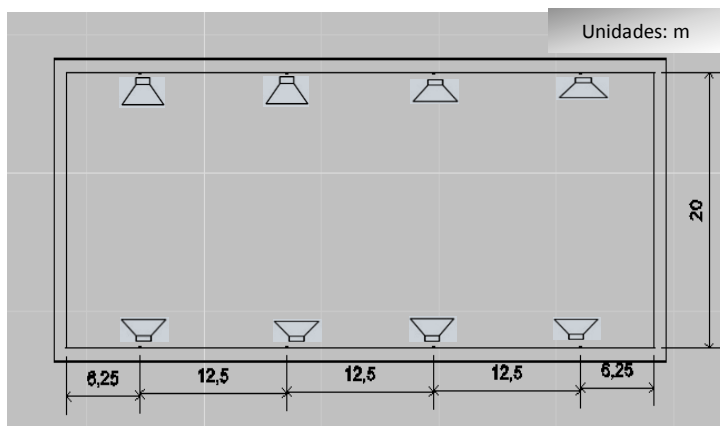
Vista de la distribución de los altavoces en plano de planta
